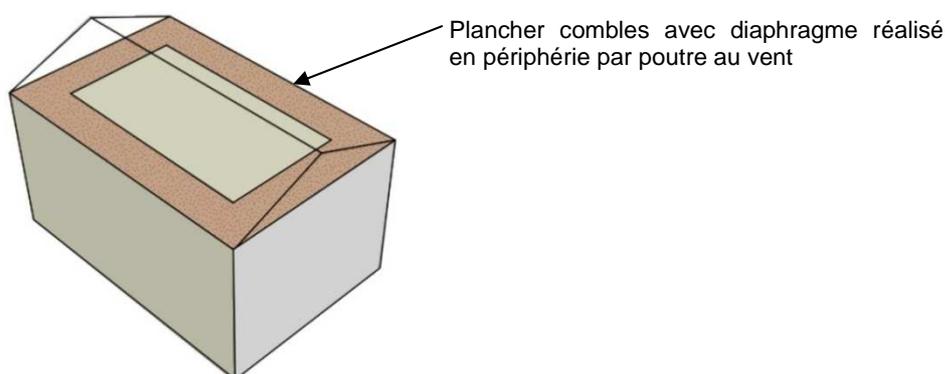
Exemple schématique de localisation du contreventement horizontal à la périphérie d'un plancher.
